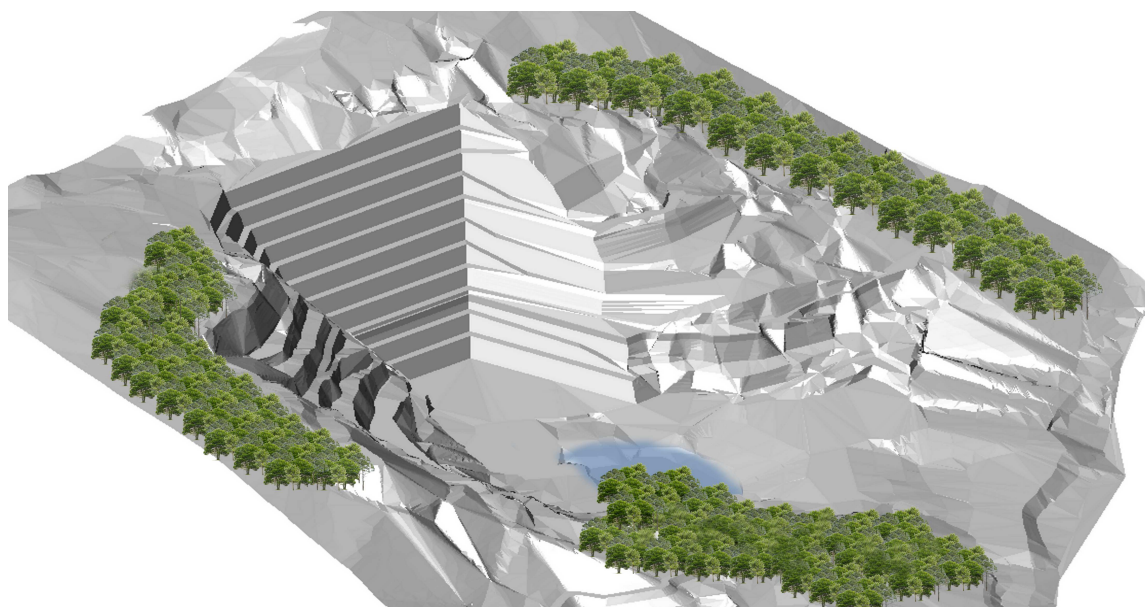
Esquema com intervenção proposta na fase 1 do PARP.
